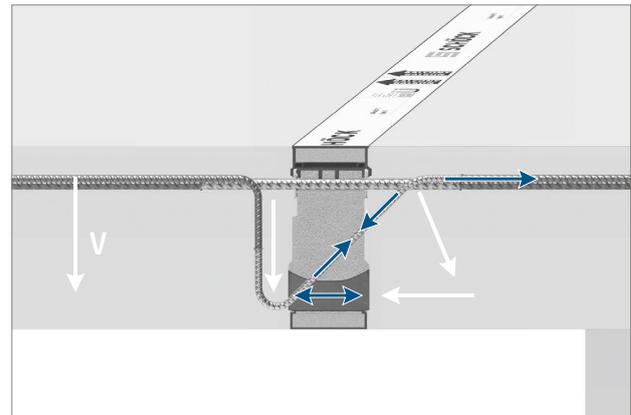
Schöck Isokorb® T Typ KL: Lastabtragung Querkraft
